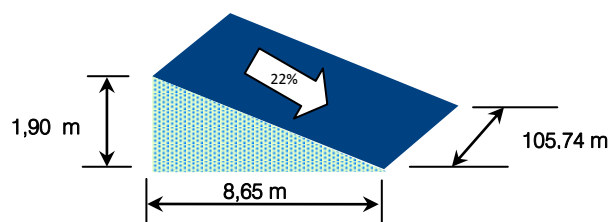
Cubierta de la fábrica en planta.
